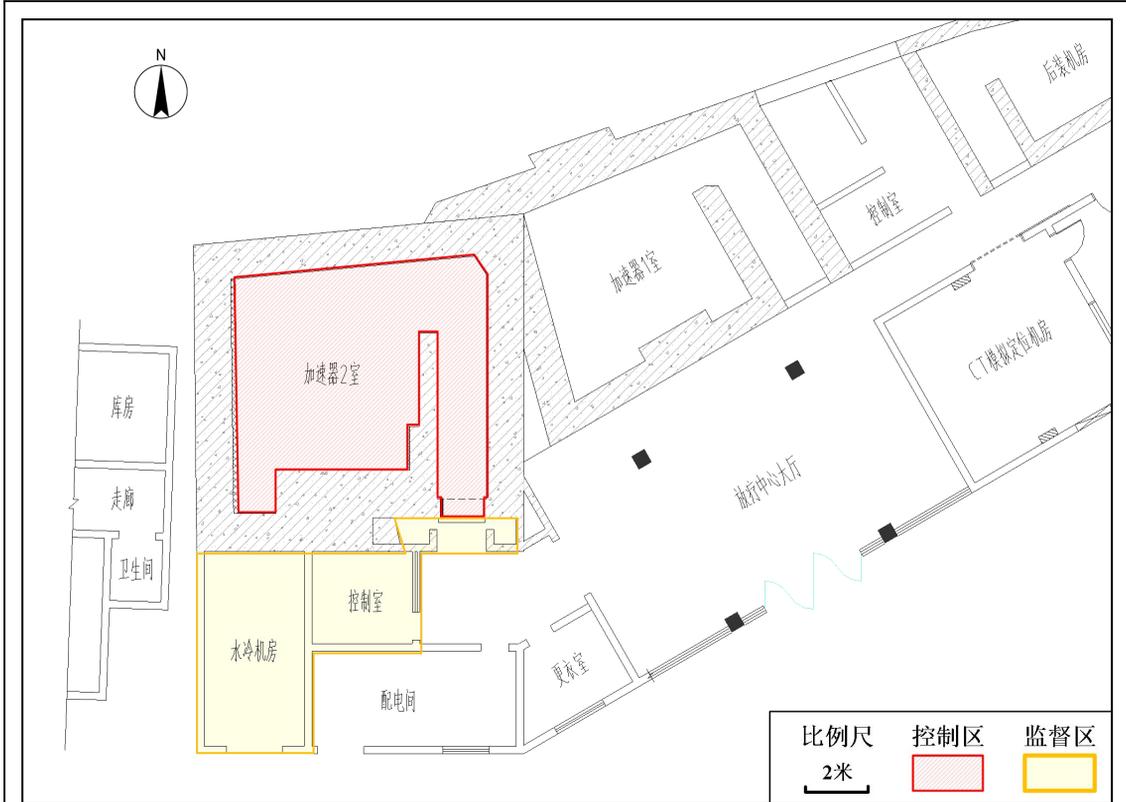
钟阜院区放疗中心一层加速器2室平面布置及分区示意图
